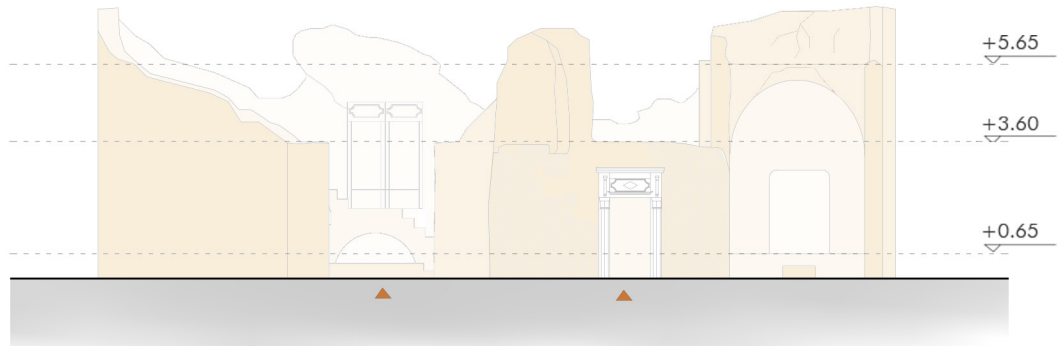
Prospetto est della casa 10. Scala 1/200
